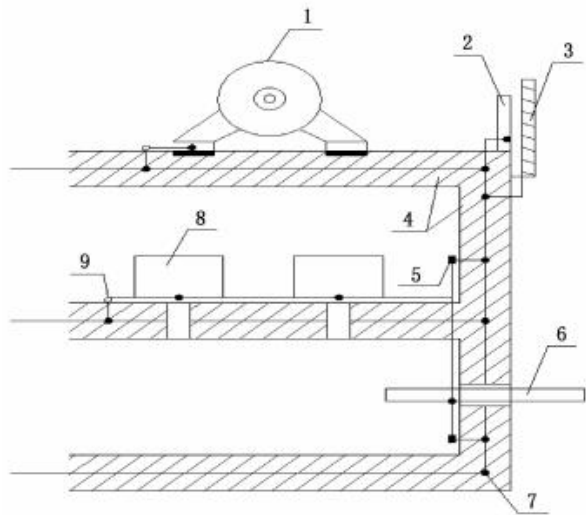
钢筋混凝土建筑物内等电位连接示意图
